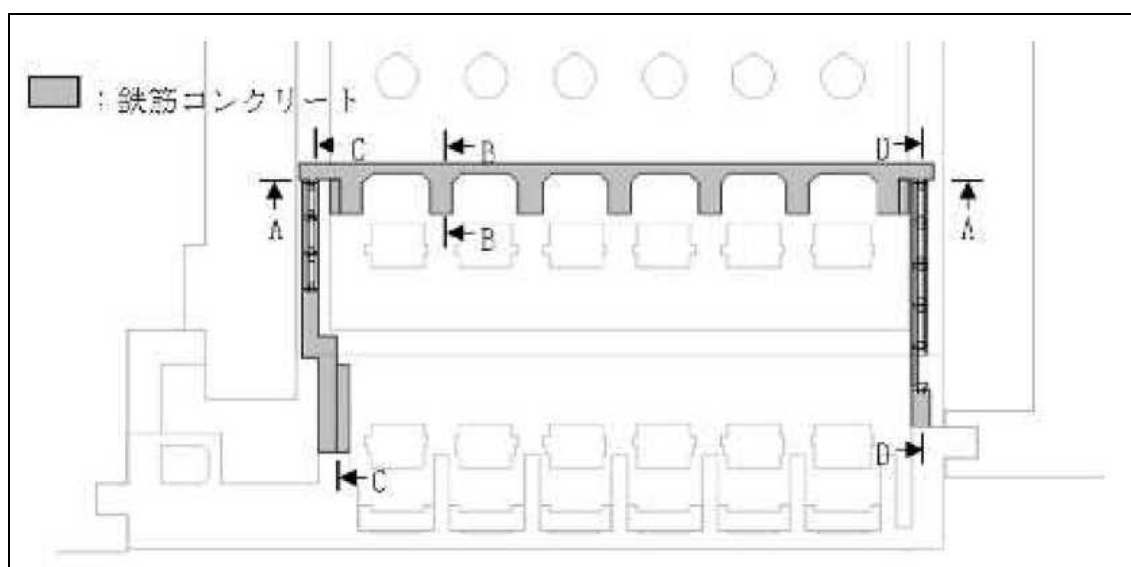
止水壁平面図 (関西電力 大飯 3, 4 号炉)
